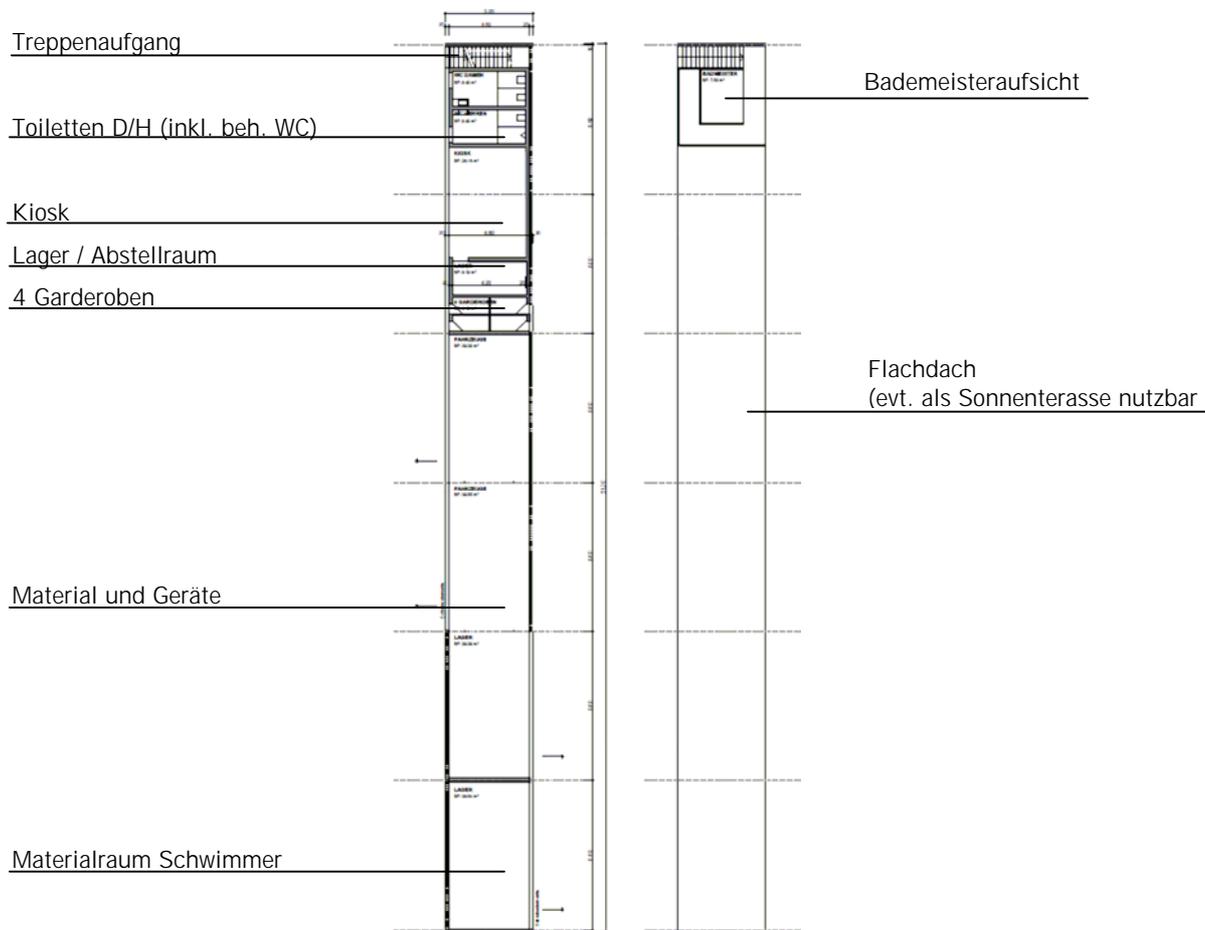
Grundriss und Funktionalität des geplanten Pavillons.
